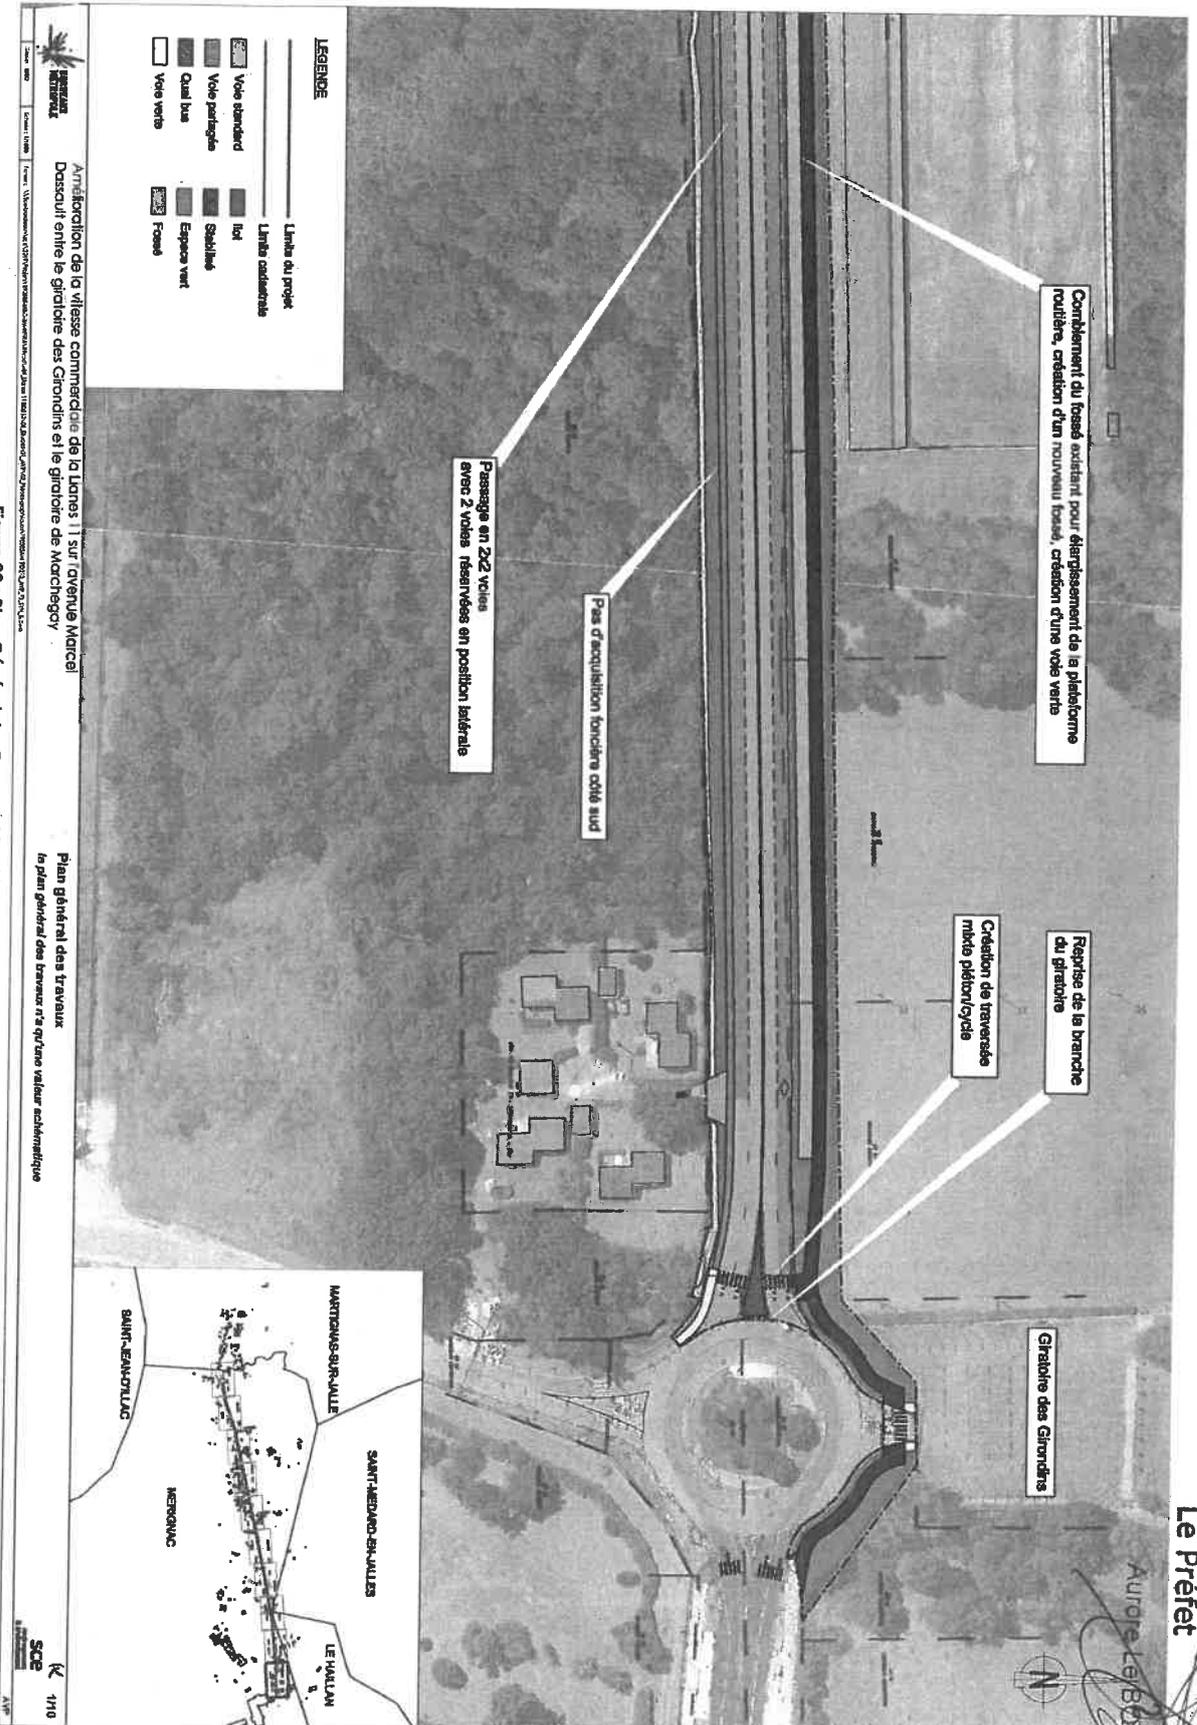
Plan Général des Travaux 10 - Giratoire Est. Source : Bordeaux Métropole
